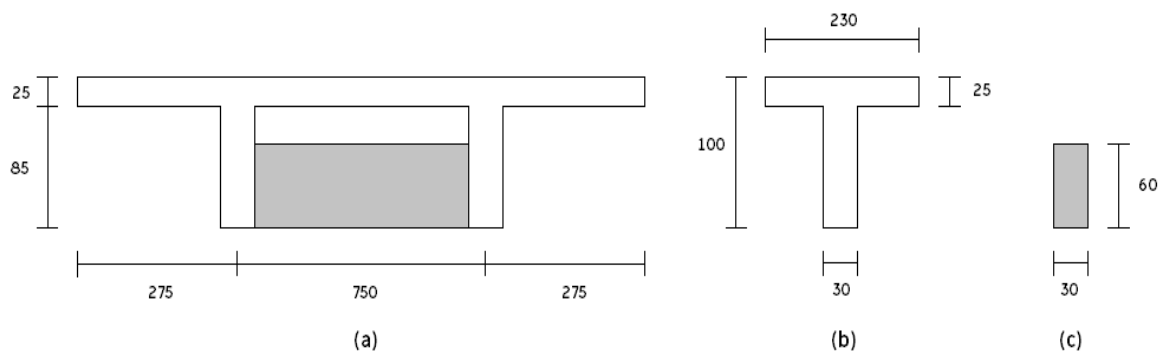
Dimensões da ponte (em cm): (a) seção transversal; (b) longarinas e (c) transversinas
